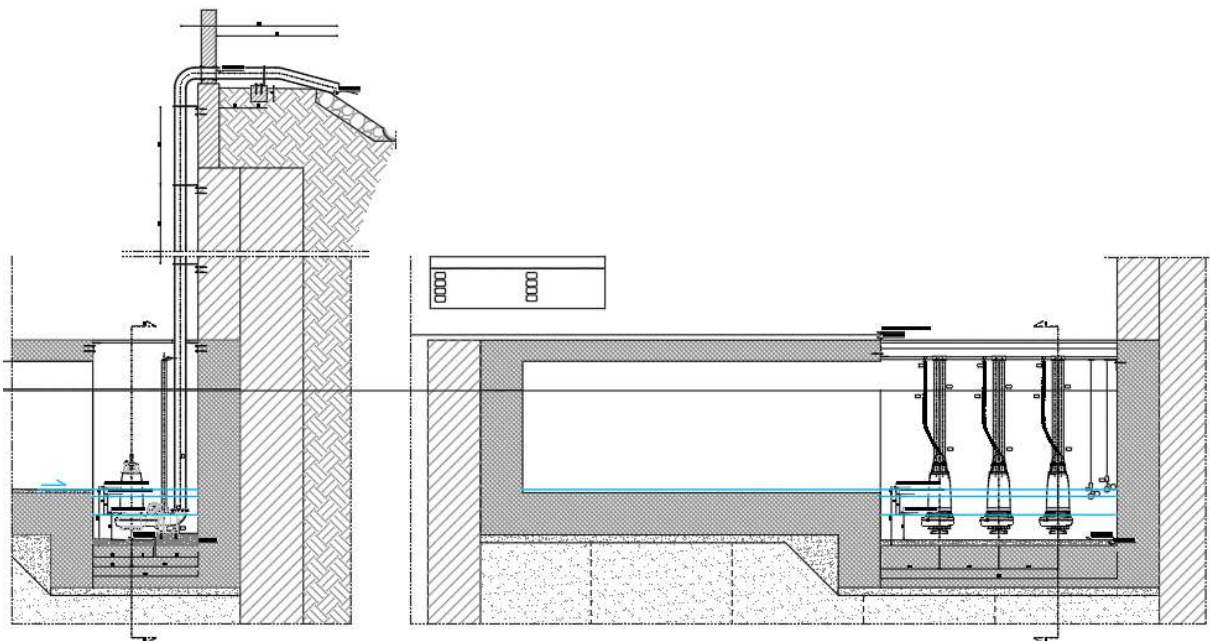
Sezione longitudinale e trasversale della stazione di sollevamento meccanico in vasca di accumulo.
